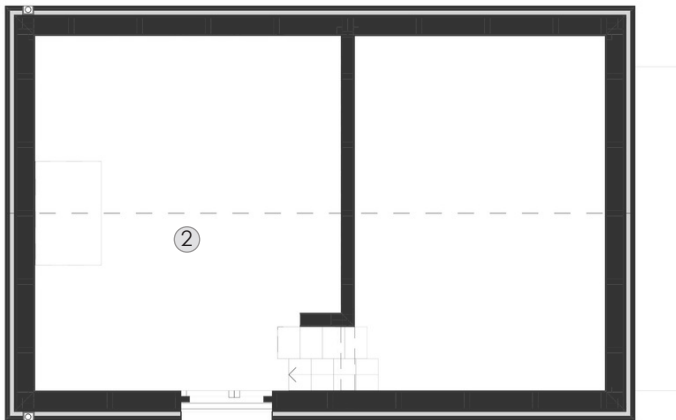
Planta mezanine. Fuente: ArchDaily, 2020
